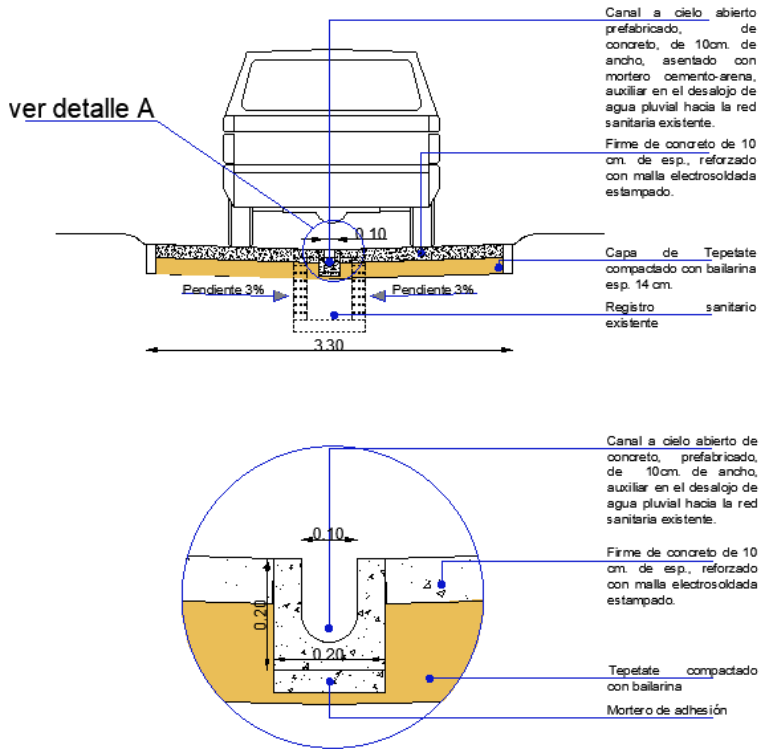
Detalle del proyecto de sustitución del material de la vialidad y su canal central. Autoría propia.
